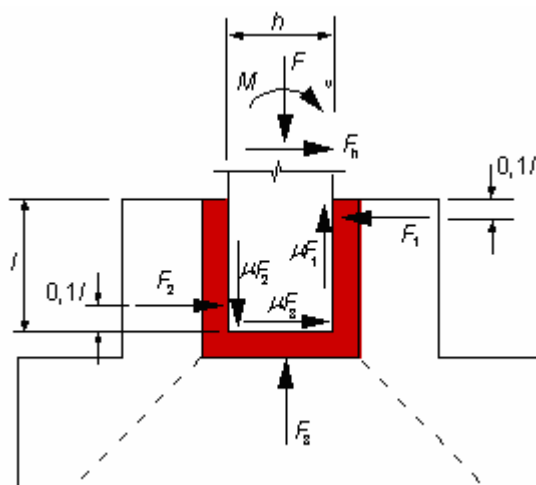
Encastramento do pilar no cálice da sapata [7]
